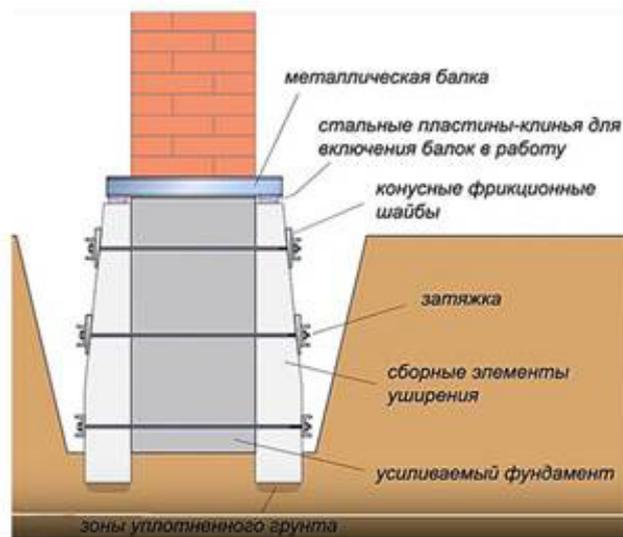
Усиление монолитного ленточного фундамента уширением основания с использованием сборных железобетонных элементов на затяжках
